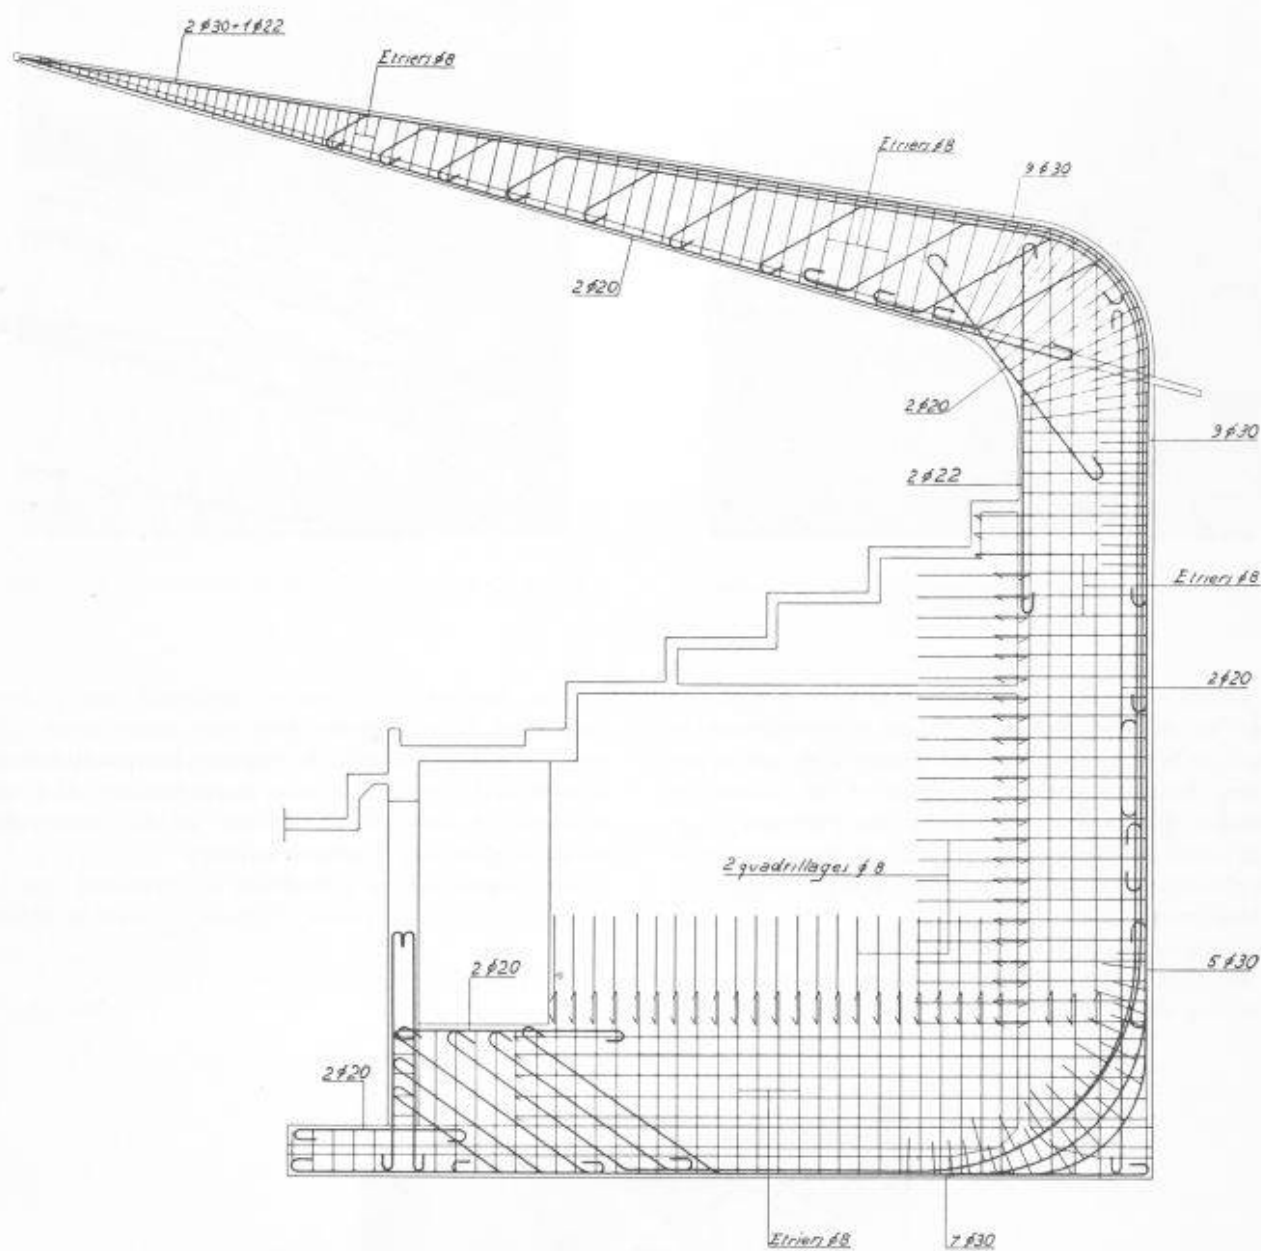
Armature d'une ferme. (Ech. 1 : 60.)
